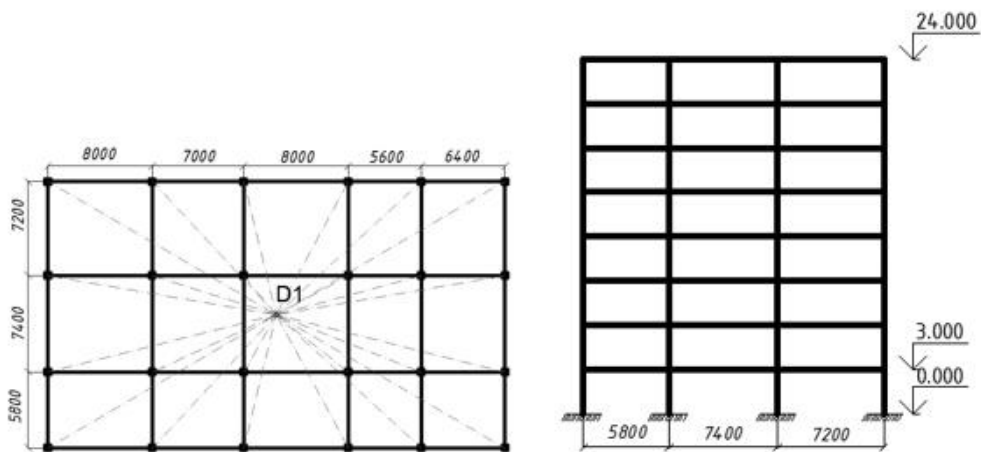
План поверху (а) та поперечний розріз (б) вихідної моделі будівлі
